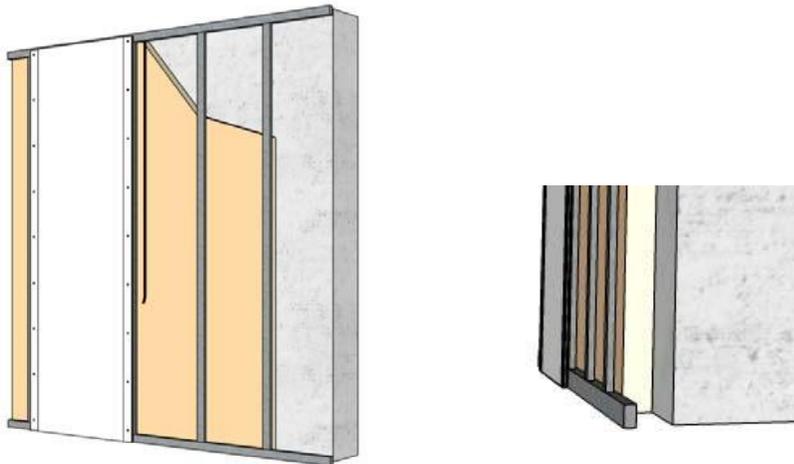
CONTRE-CLOISON EN PLAQUES DE PLATRE SUR OSSATURE METALLIQUE SANS APPUI INTERMEDIAIRE (AVEC LAME D'AIR DEVANT L'ISOLANT)
